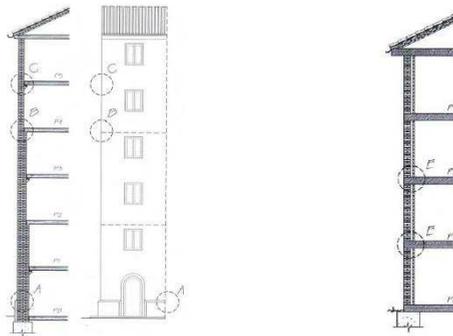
(De izq. a dcha.). Muro ladrillo macizo y muro de principios s. XX. Fuente: Adell, J. (2000). *Arquitectura sin fisuras*. Munillaleria. Citado en Cruz, A. (2011). *PFC-UPV. Estabilidad de las fábricas de ladrillo, según CTE*. Valencia.
